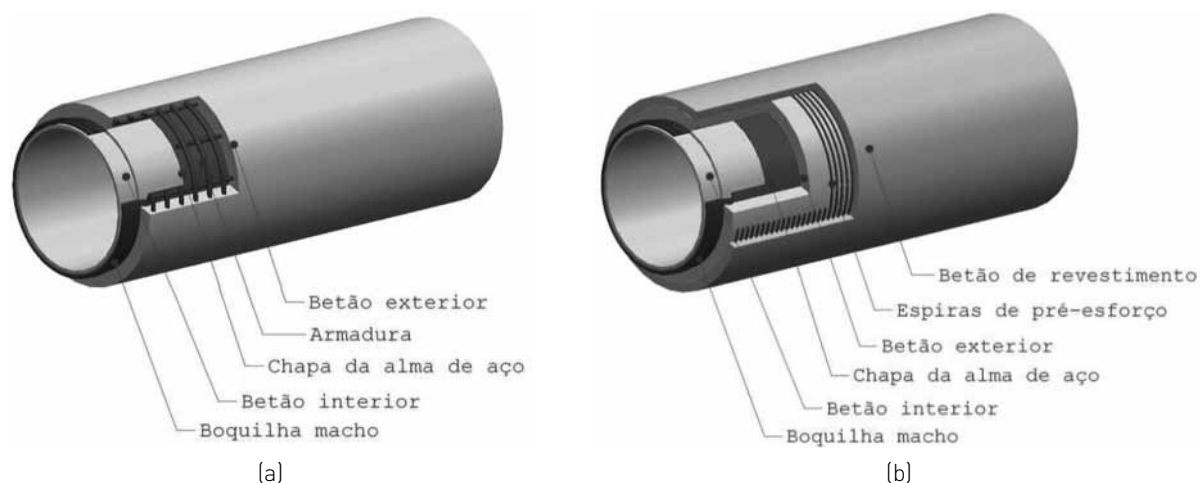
Tubagem de Betão (a) Armado com Alma de Aço e (b) Pré-esforçado com Alma de Aço
